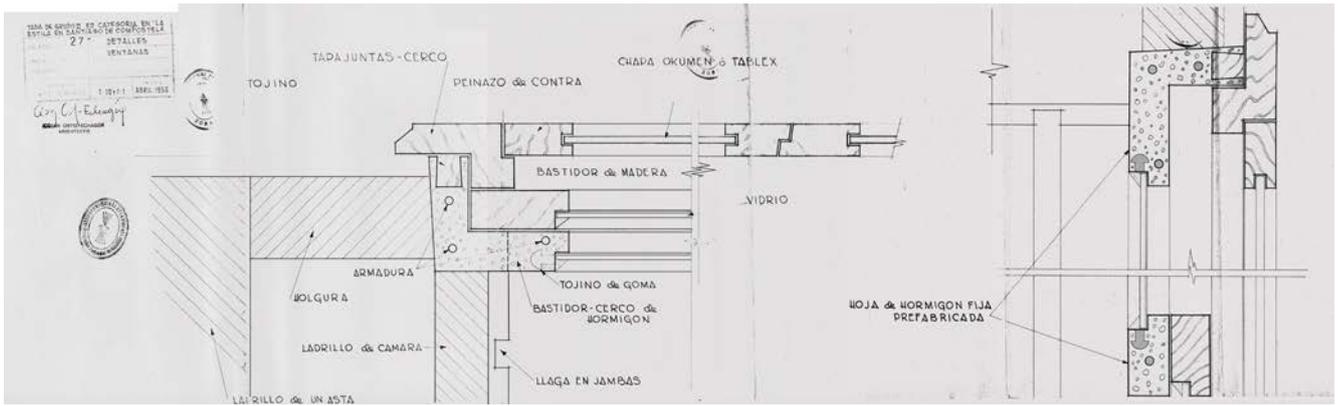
Pormenor del Plano N° 27. Detalles Ventanas. Escala 1:10 y 1:1. Abril 1956. Muestra la sección horizontal y vertical de la ventana tipo.
